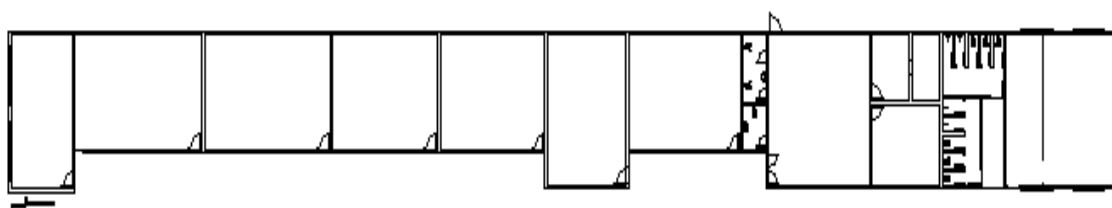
Planta Baixa Escola Municipal Antônio Rocha Loures
